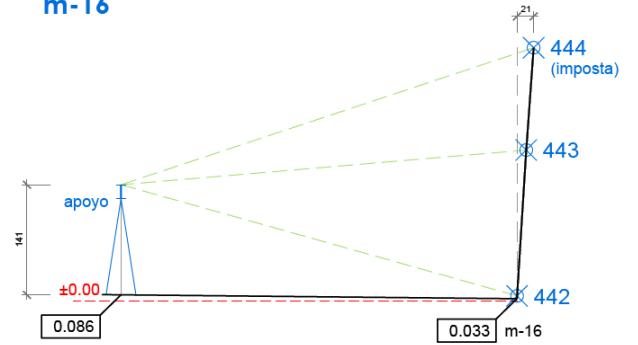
Levantamiento de muro Norte de la nave (elaboración propia).
